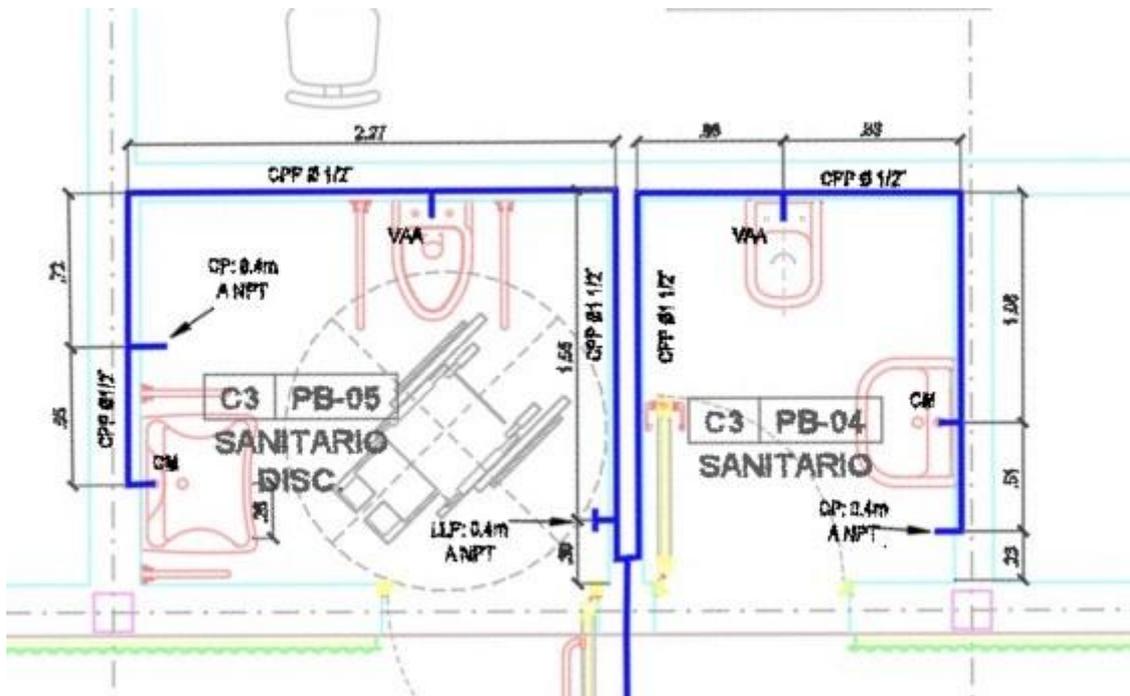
Sanitarios públicos, en edificio C3 de planta baja del Sector 1 Paso Fronterizo de La Quiaca.
